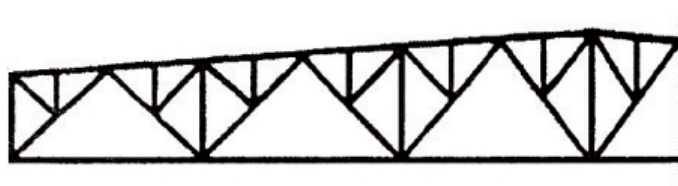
Grila trapeze me diagonale dhe vertikale të veçanta
